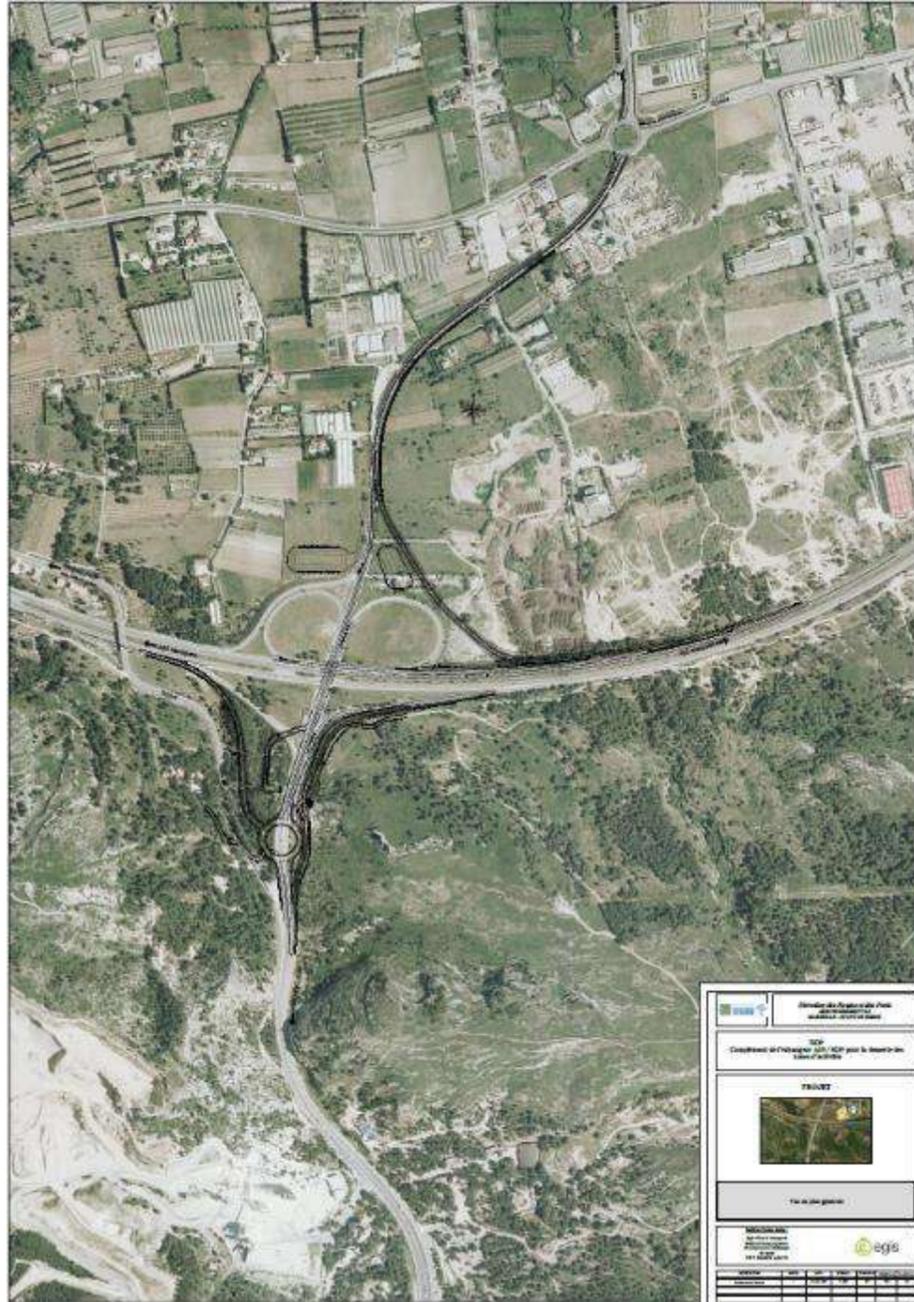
Vue en plan générale des emprises finales du projet sur orthophoto (Source : EGIS, 2019)
